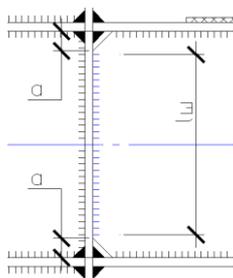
Сварной шов стенки консоли и полки колонны
